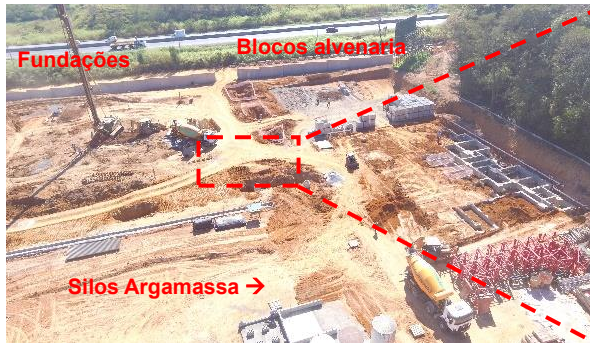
Registro com RPAS da finalização de concretagem dos blocos e vigas da fundação.
